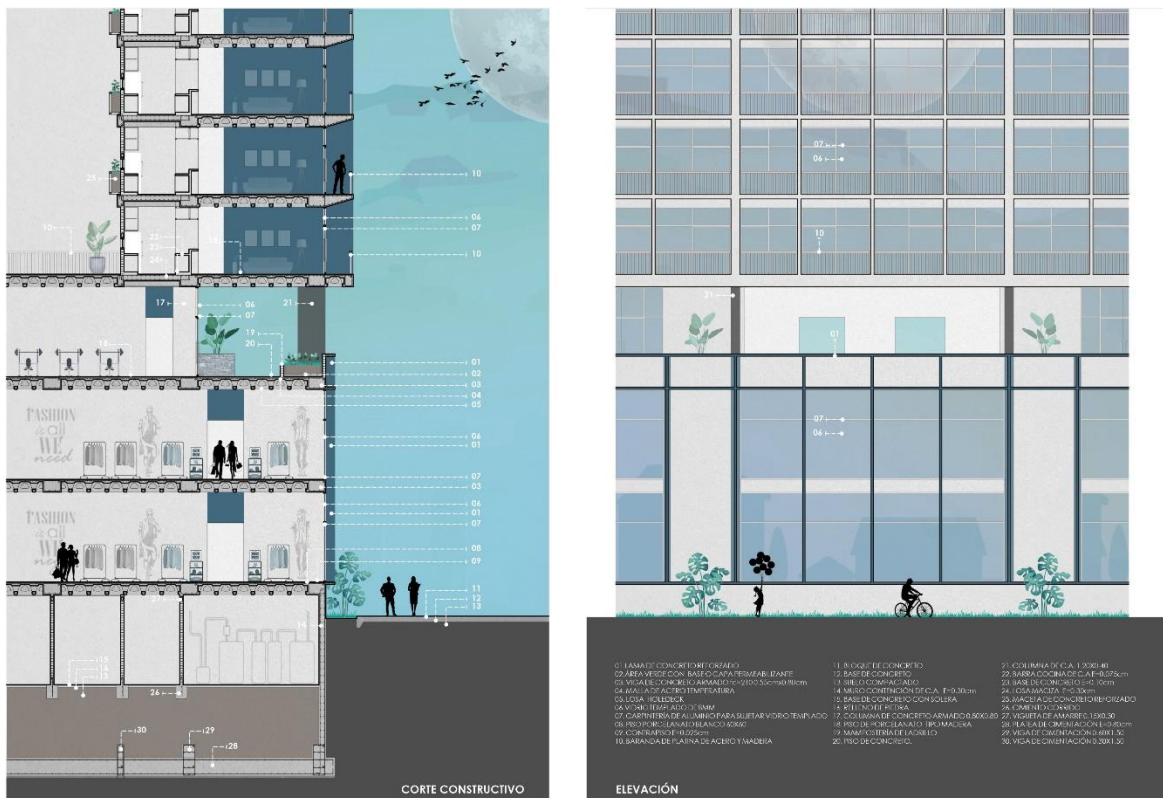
Cortes Arquitectónico - Anteproyecto.
